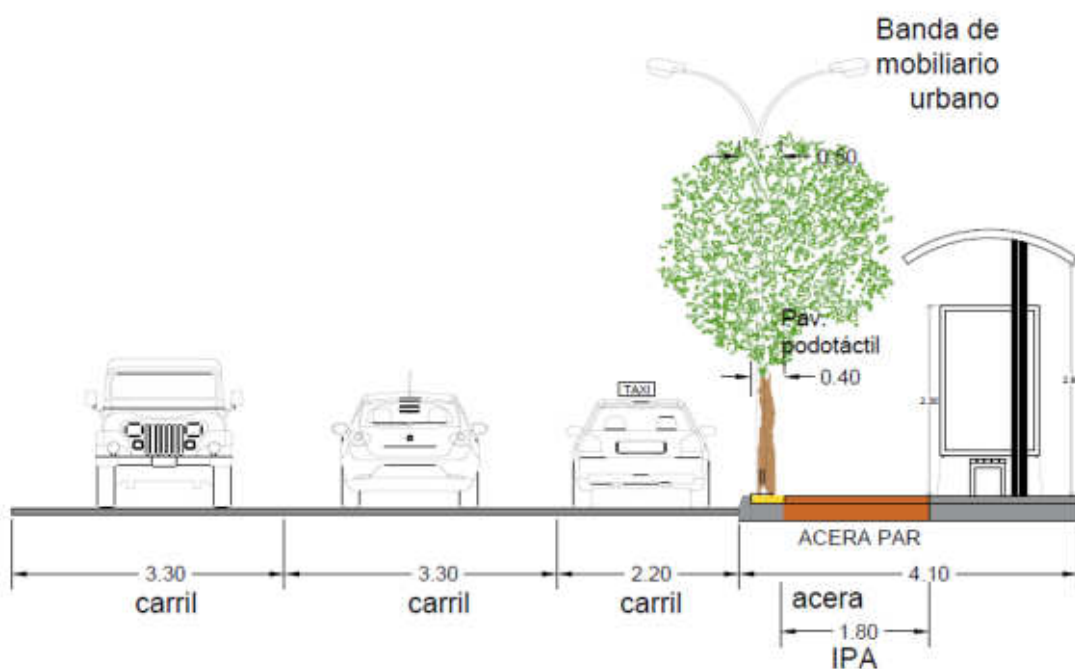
Sección en alzado de la propuesta de actuación en las paradas de taxis.
